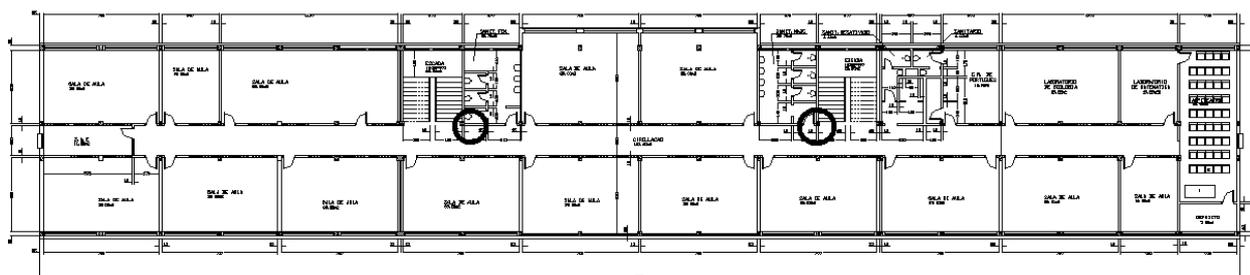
Localização sugerida para os acionadores do sistema de alarme de incêndio no terceiro pavimento.
